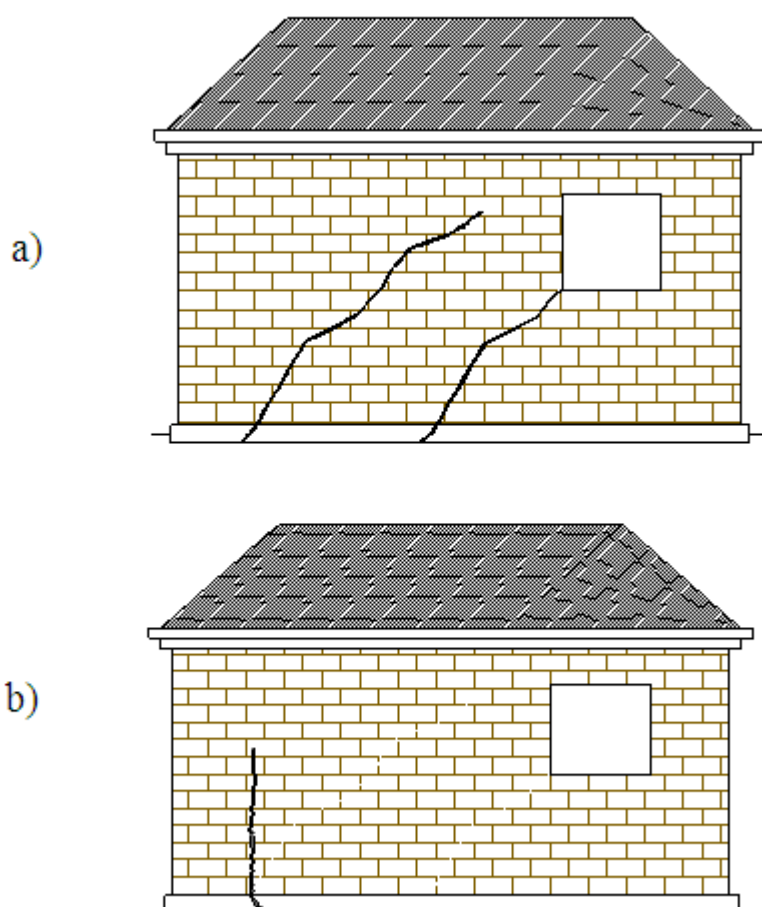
Возникновение трещин в наружных стенах зданий.
